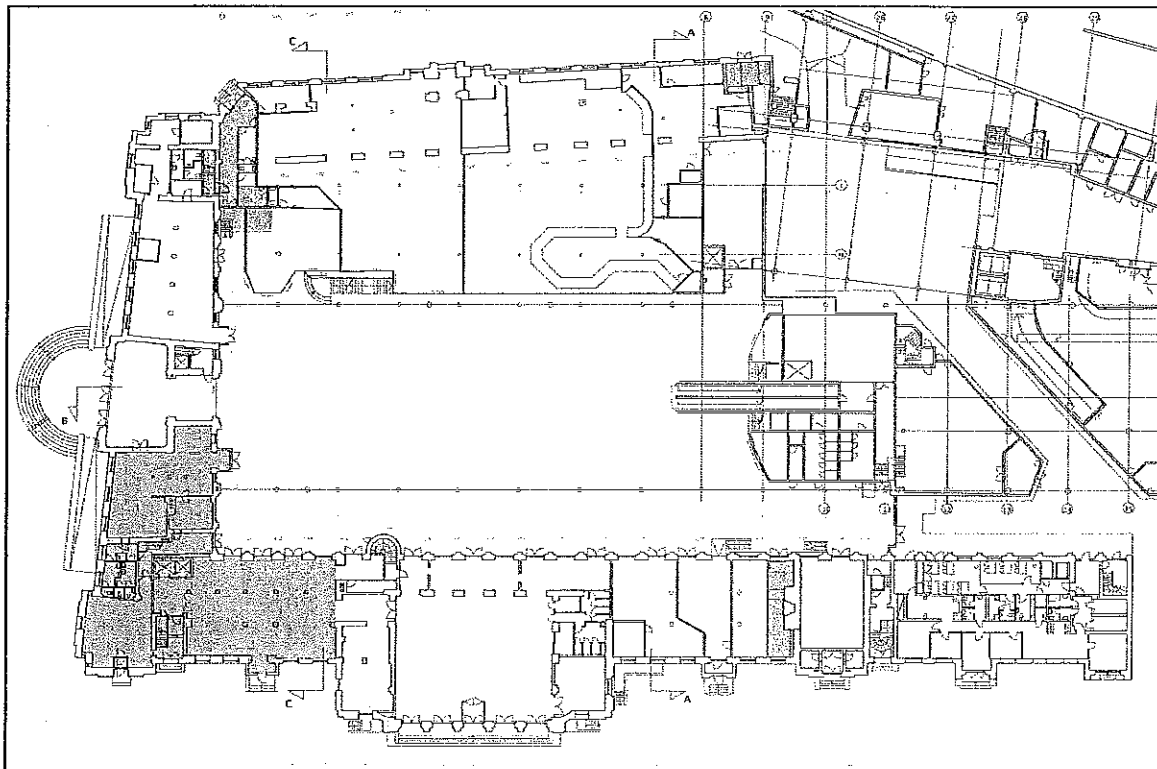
Plan 1. etasje. Arealer merket med grønt plan legges tatt i bruk til hotell
